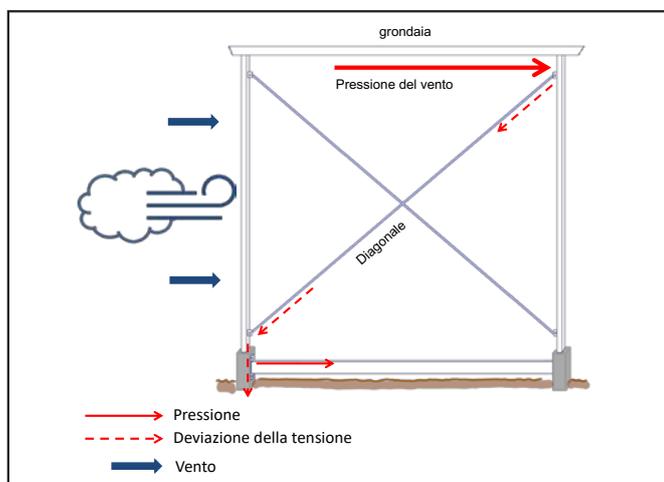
Croce Frangivento. La pressione del vento è scaricata dalla grondaia sulla diagonale creando tensione. La diagonale devia (scarica) la tensione sulle fondamenta.
